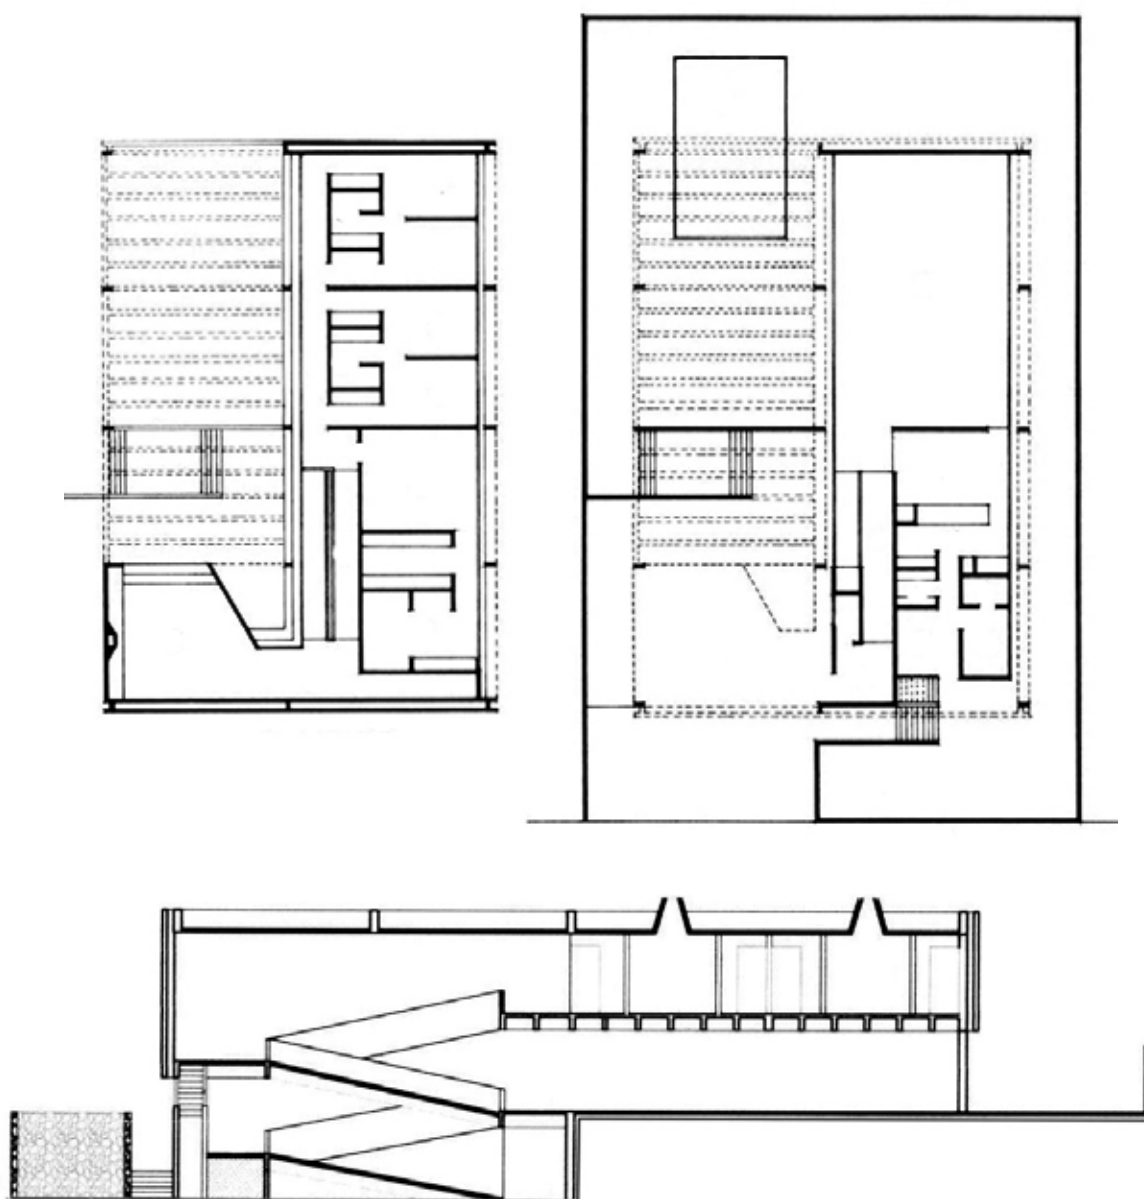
Casa Edgard Niclewicz (1979); planta pavimento superior.
